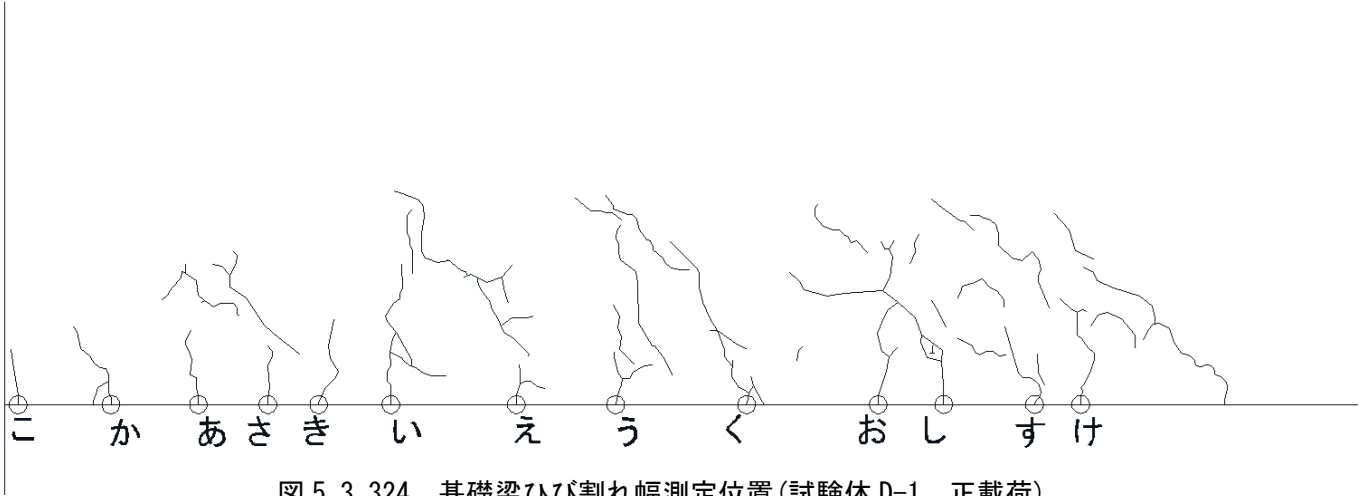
基礎梁ひび割れ幅測定位置(試験体 D-1 正載荷)
